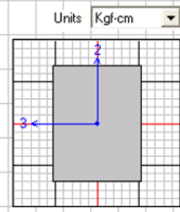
Cuadro de Detalle, Viga de Carga 2 según ejes establecidos en los planos estructurales.
